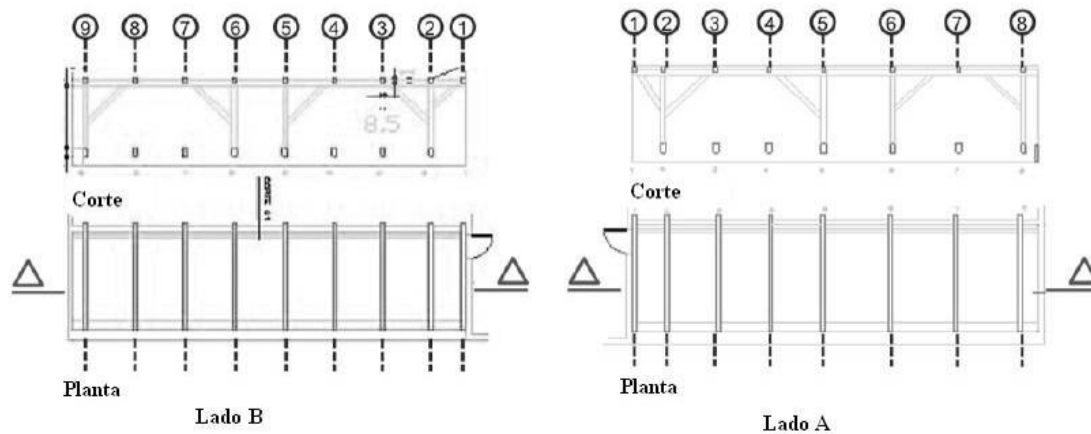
Planta e corte longitudinal das partes inspecionadas da cobertura.
